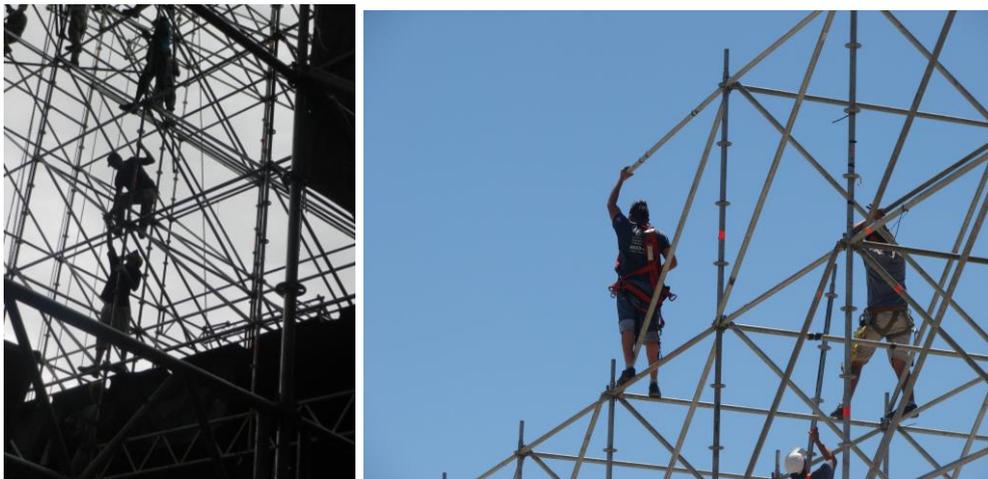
Trabajadores elevando las piezas de estructura tubular metálica
